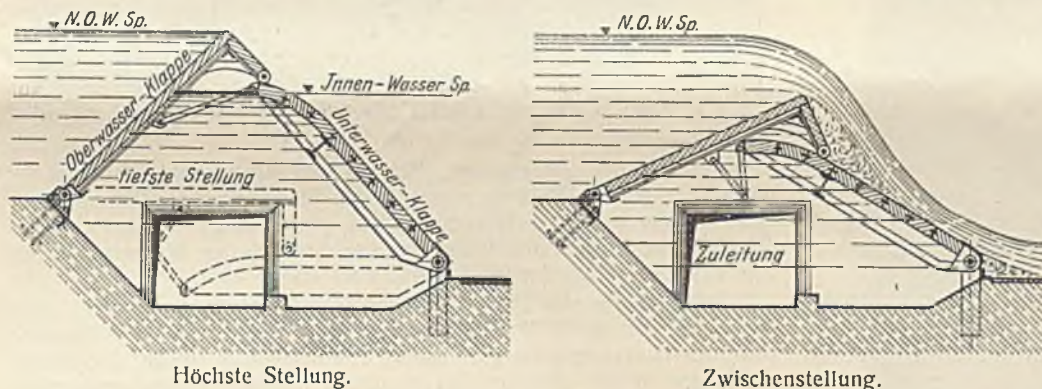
Querschnitte durch das hydraulische Dachwehr.
